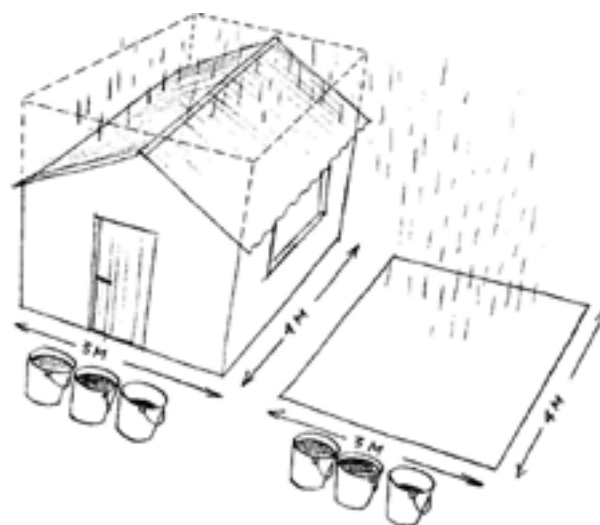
Plan horizontal de la superficie du toit (Source : <http://www.fpvimage.co/how-to-calculate-the-area-of-a-roof/>)
